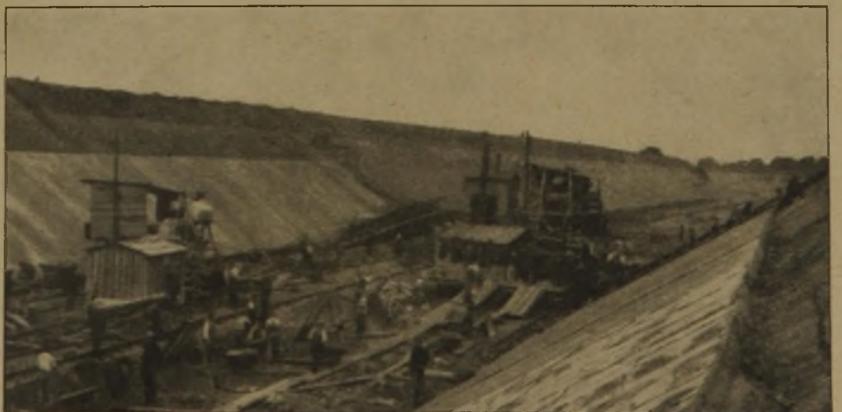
Staustufe Wieblingen. Maschinelle Herstellung der Betondeckung der Kanalböschungen
